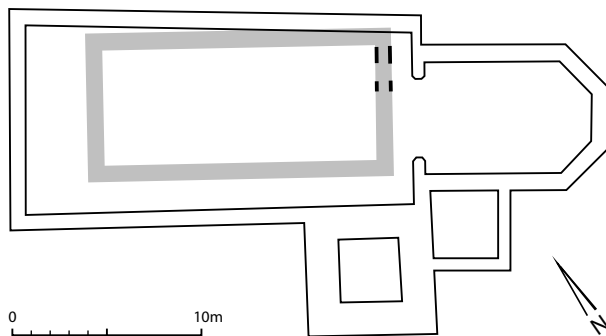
Worb, Kirche. Frühmittelalterliche Steinkirche? Frei rekonstruierter Grundriss. M. 1:400.
